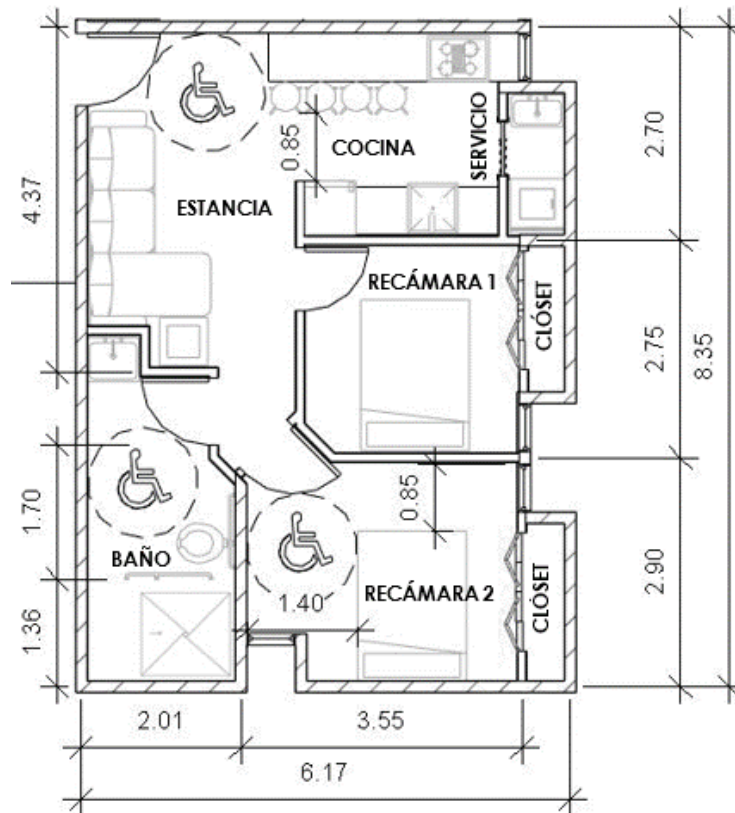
Planta arquitectónica de Vivienda tipo “B”
